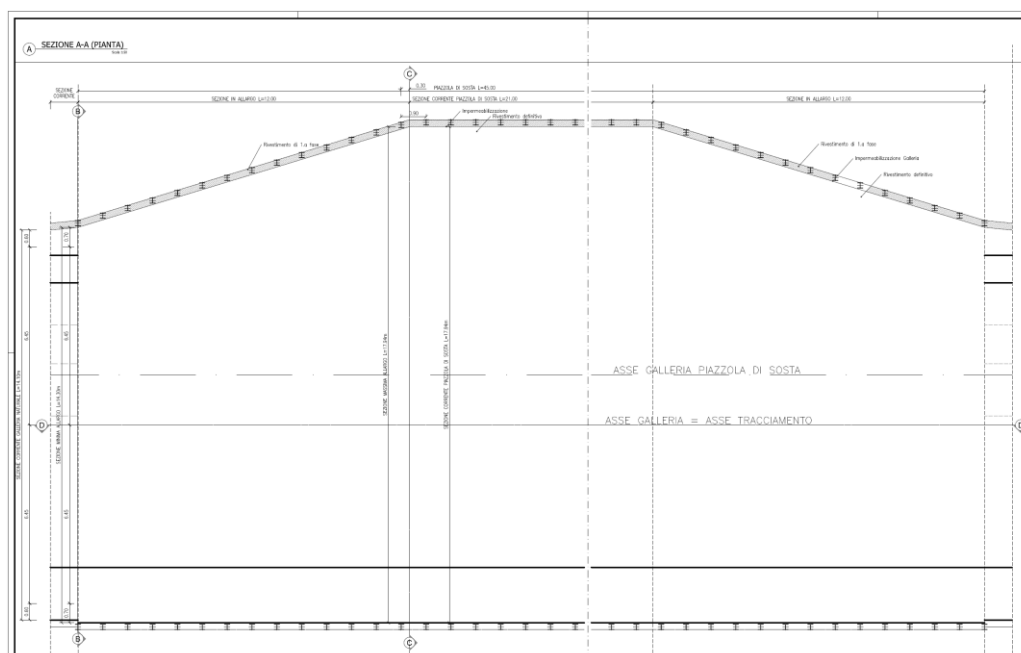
Schema “tipo” planimetrico della piazzola di sosta di P.E.D.
